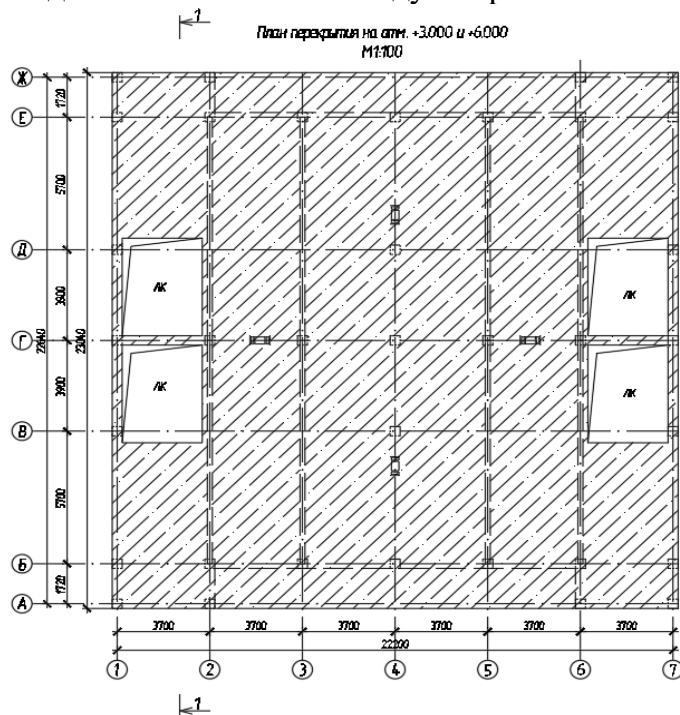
План междуэтажного перекрытия, М 1:100
